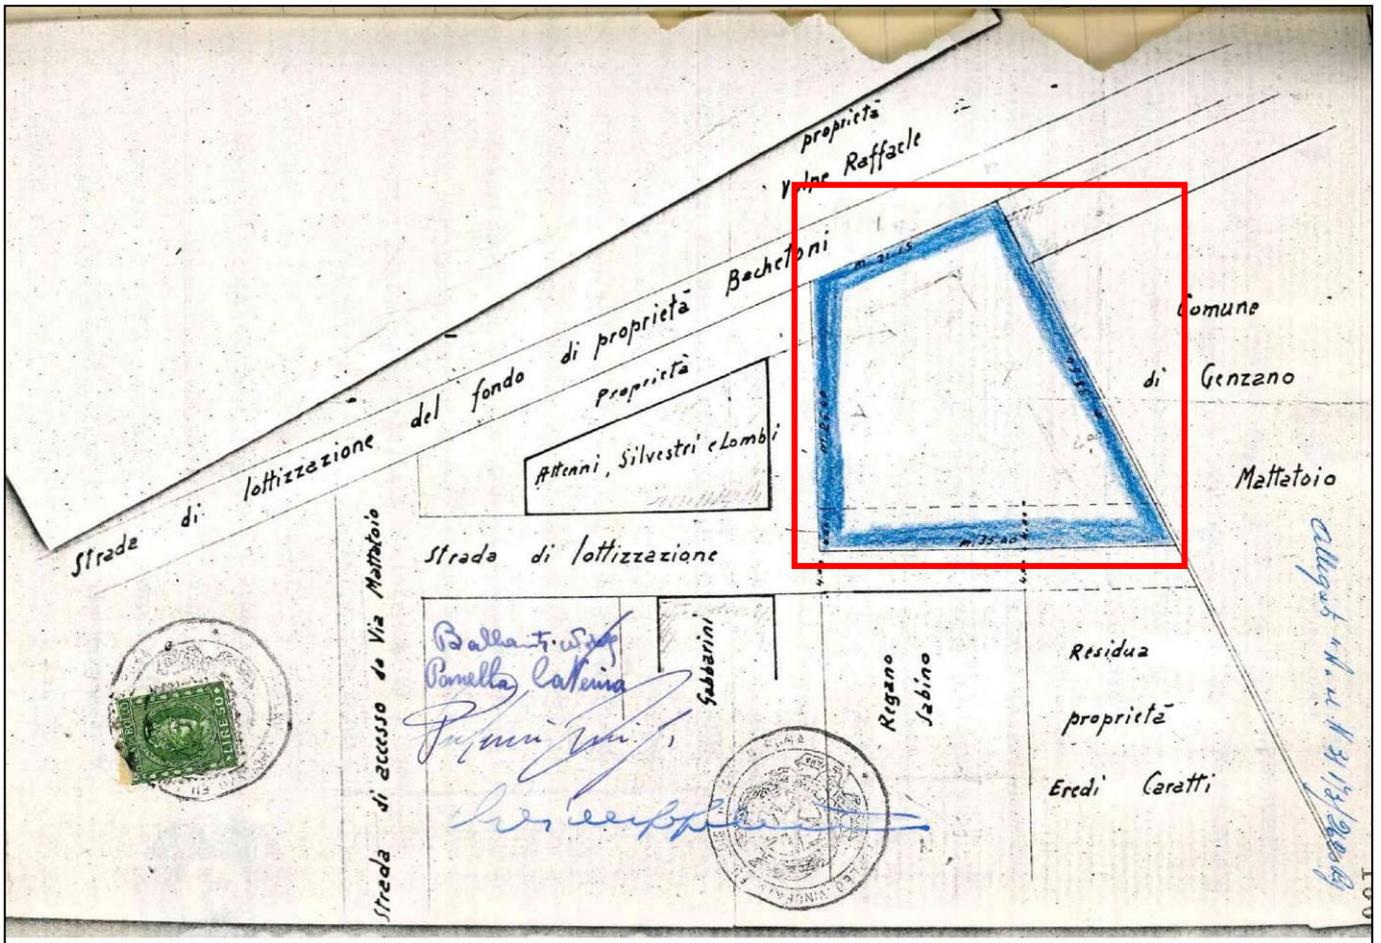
Planimetria allegata all'atto di compravendita del 1968 con individuazione del lotto di terreno
